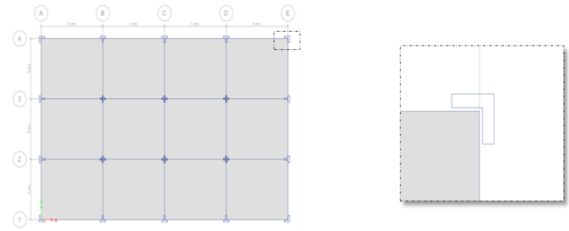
Bentuk dan ukuran kolom pipih yang dipakai.
